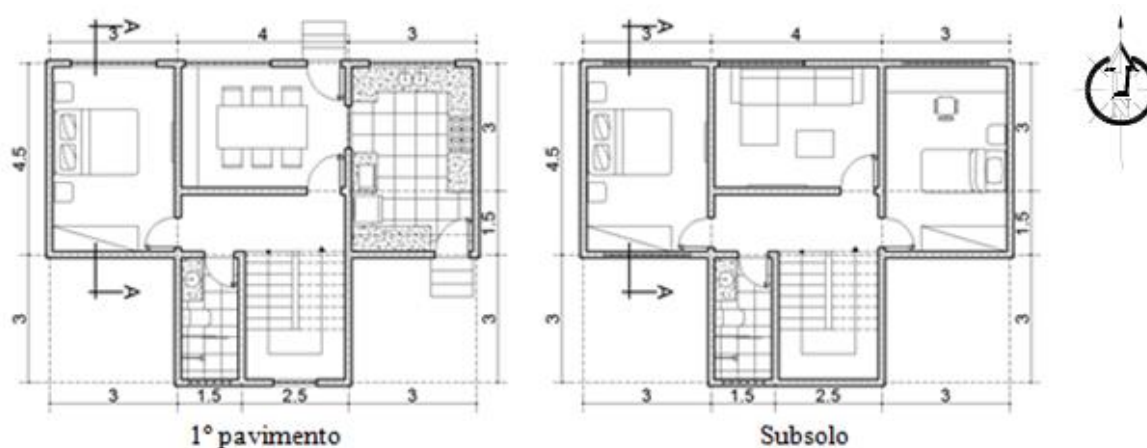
Planta baixa esquemática do objeto de estudo (cotas em metros).
